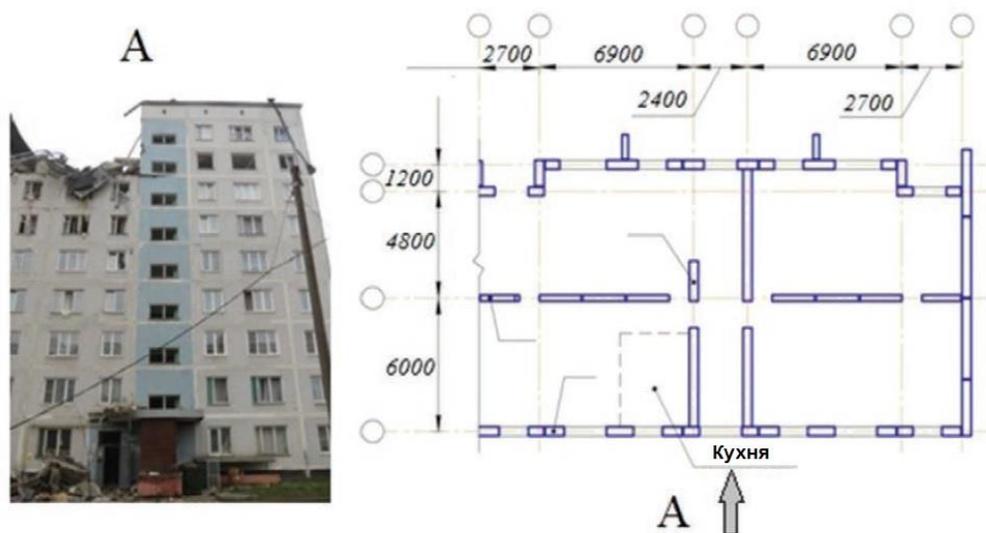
Разрушение конструкций жилого дома после взрыва газа на кухне квартиры восьмого этажа (1-наружная продольная панель стен из керамзитобетона, 2 внутренние продольные бетонные панели стены, 3 - внутренняя поперечная стена из бетонных блоков)
